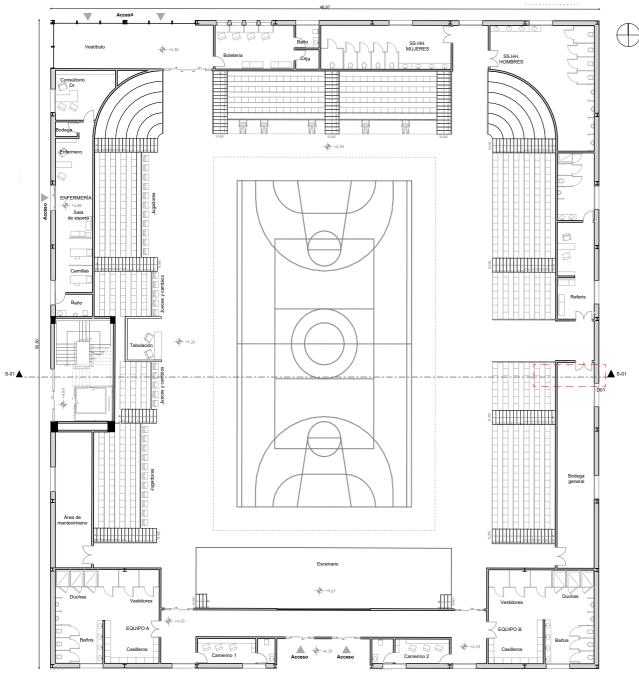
Bloque 1 - planta baja ESC_1:325 Elaborado por: Autor
